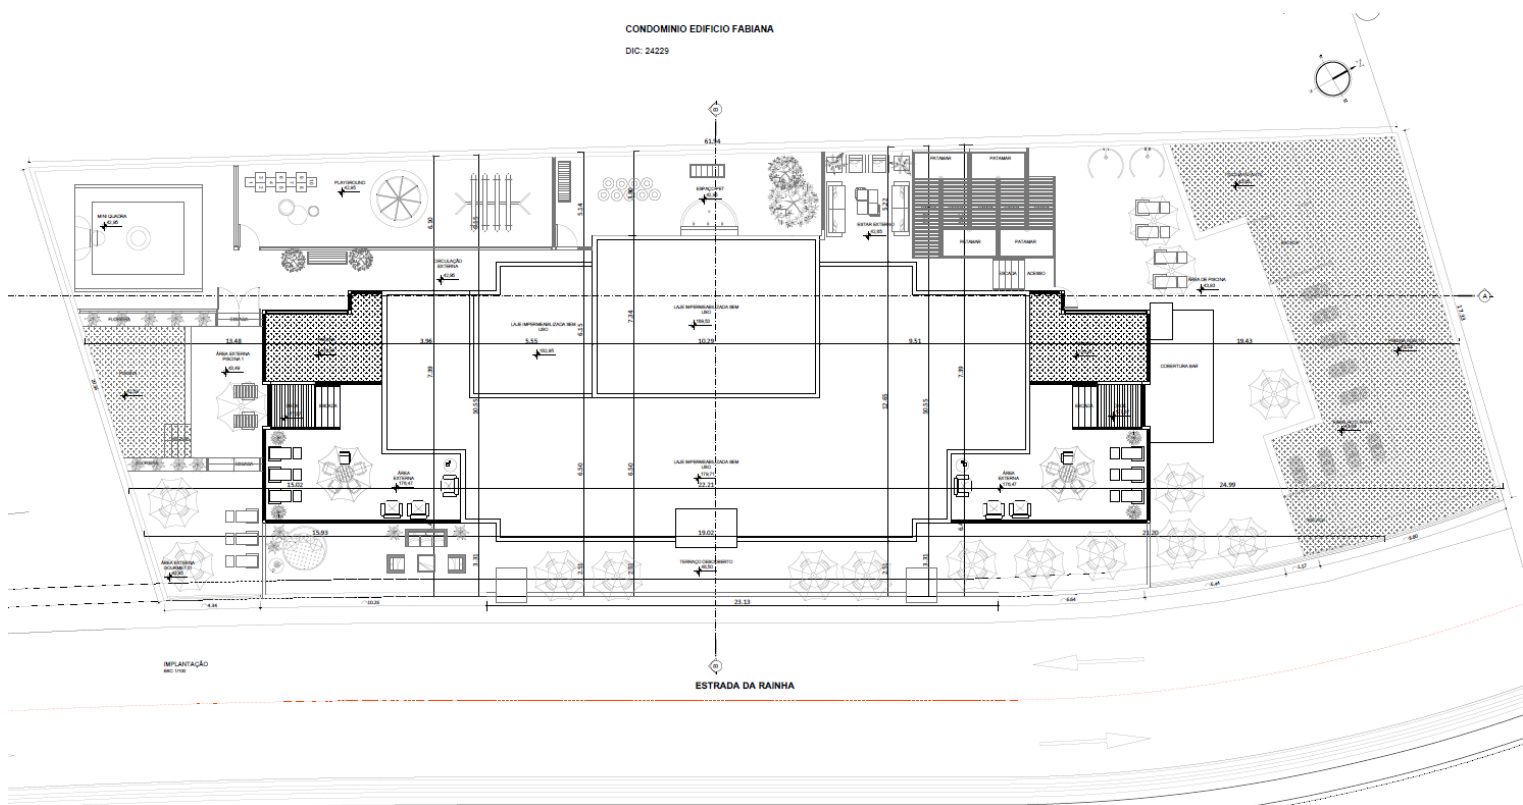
Croqui de instalação do empreendimento. Fonte: L.D.D Arquitetura Contemporânea, 2026.
